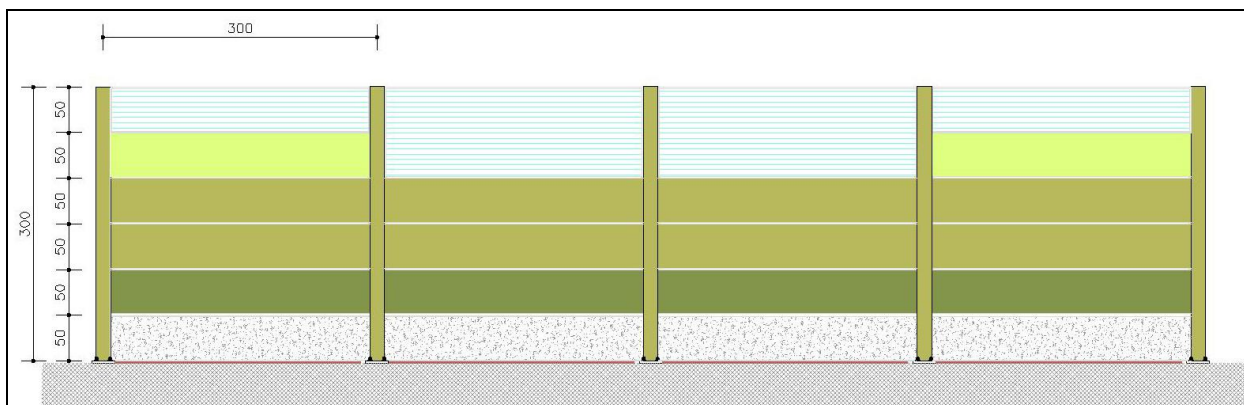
/35 Stralcio di prospetto di barriera antirumore
